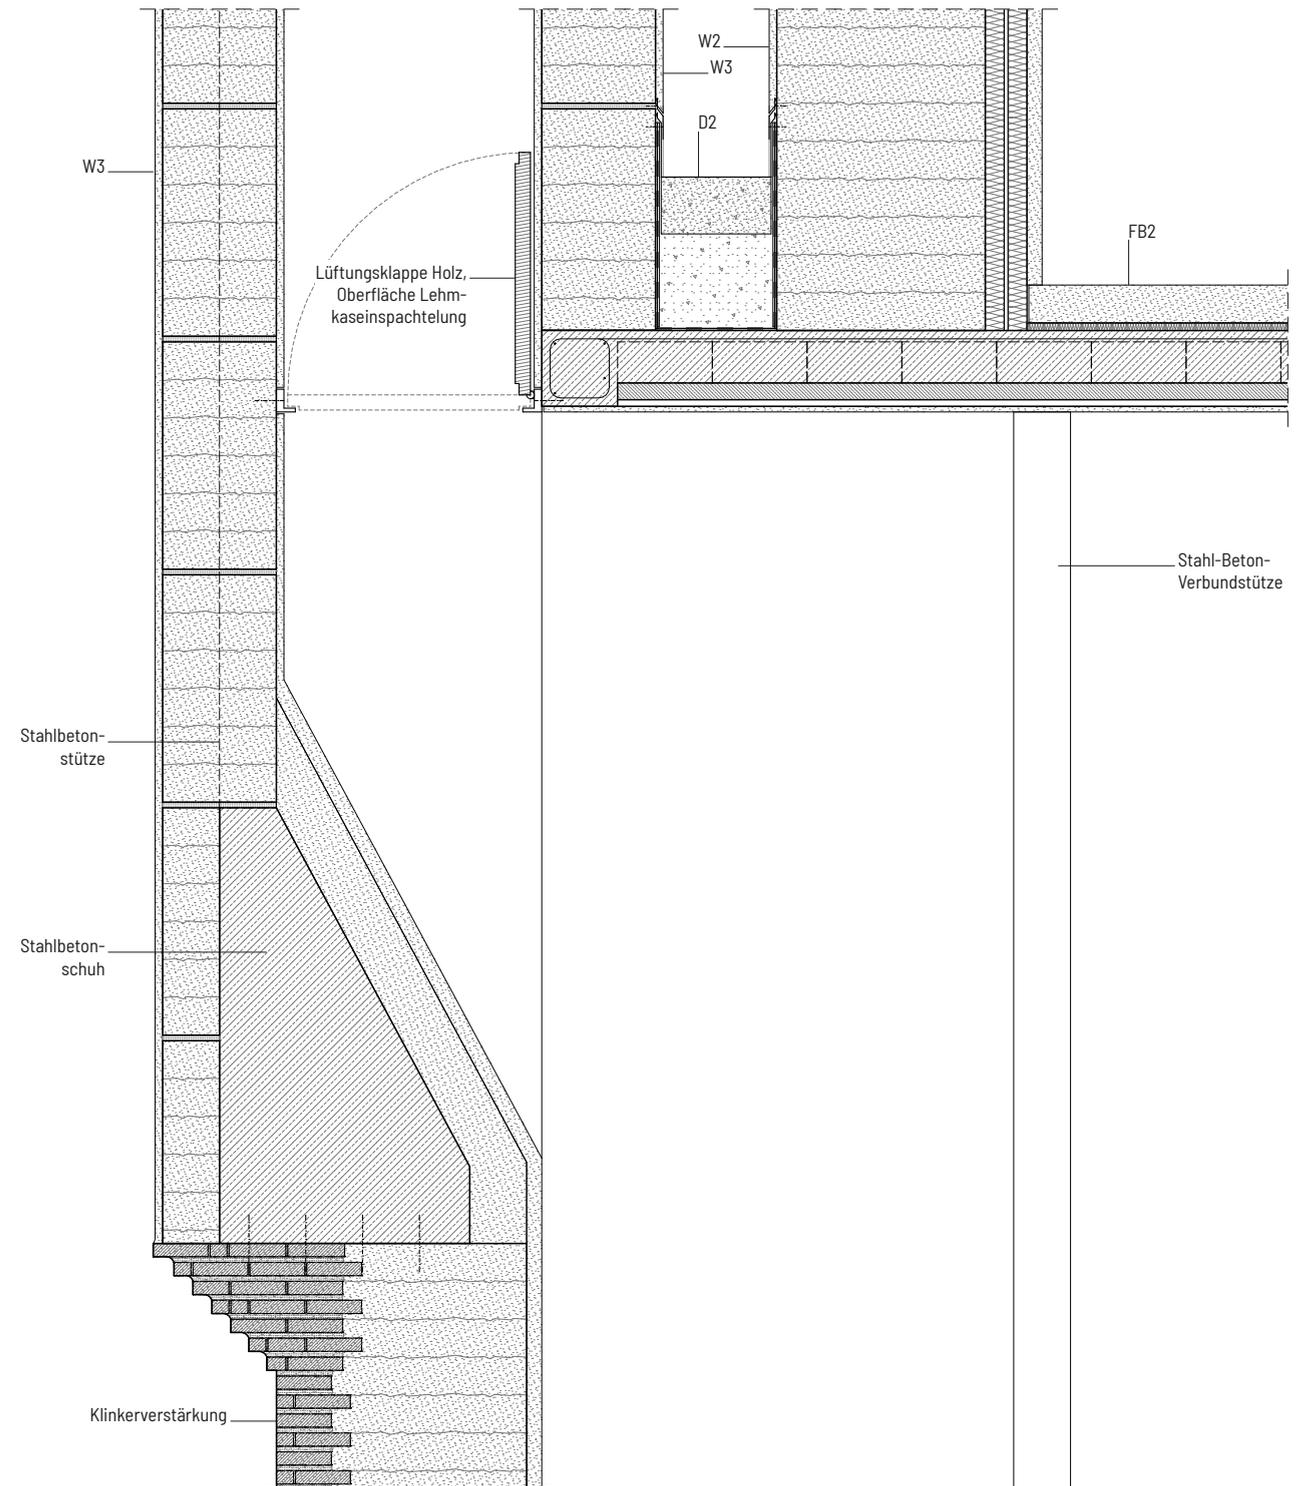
| Detail Windturm Lüftungsklappe, M 1:20
